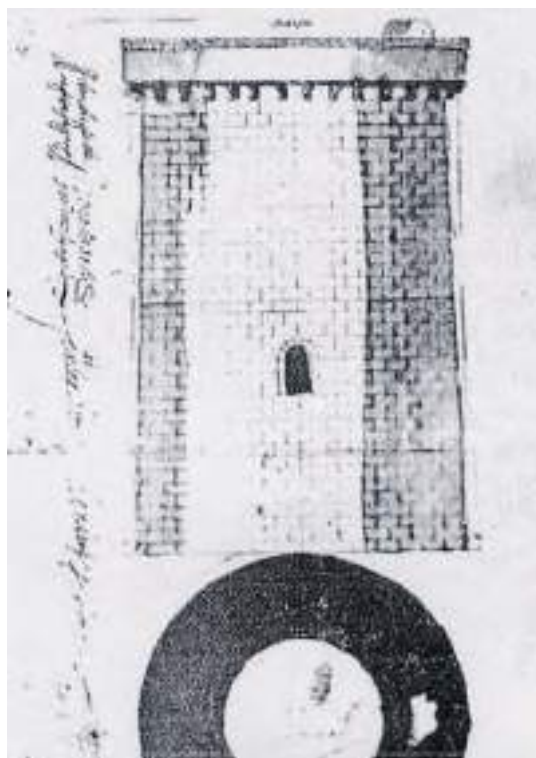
Dibujo de la planta y el alzado de la torre defensiva de El Pinatar. Fuente: regmurcia.com.
